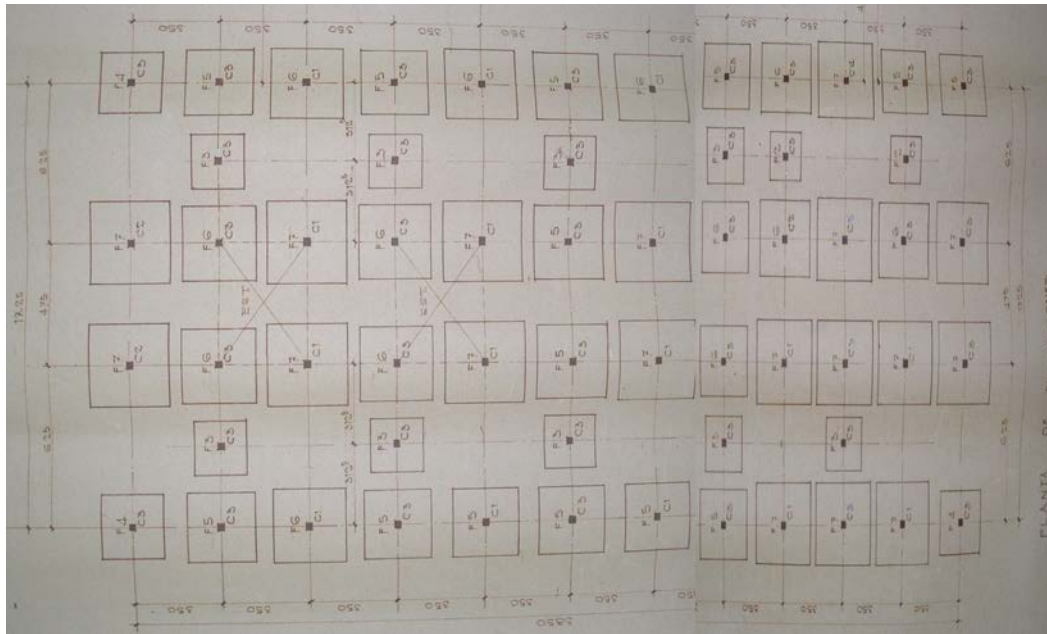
Detalles de losa de fundación. Tipo Antiguo II
